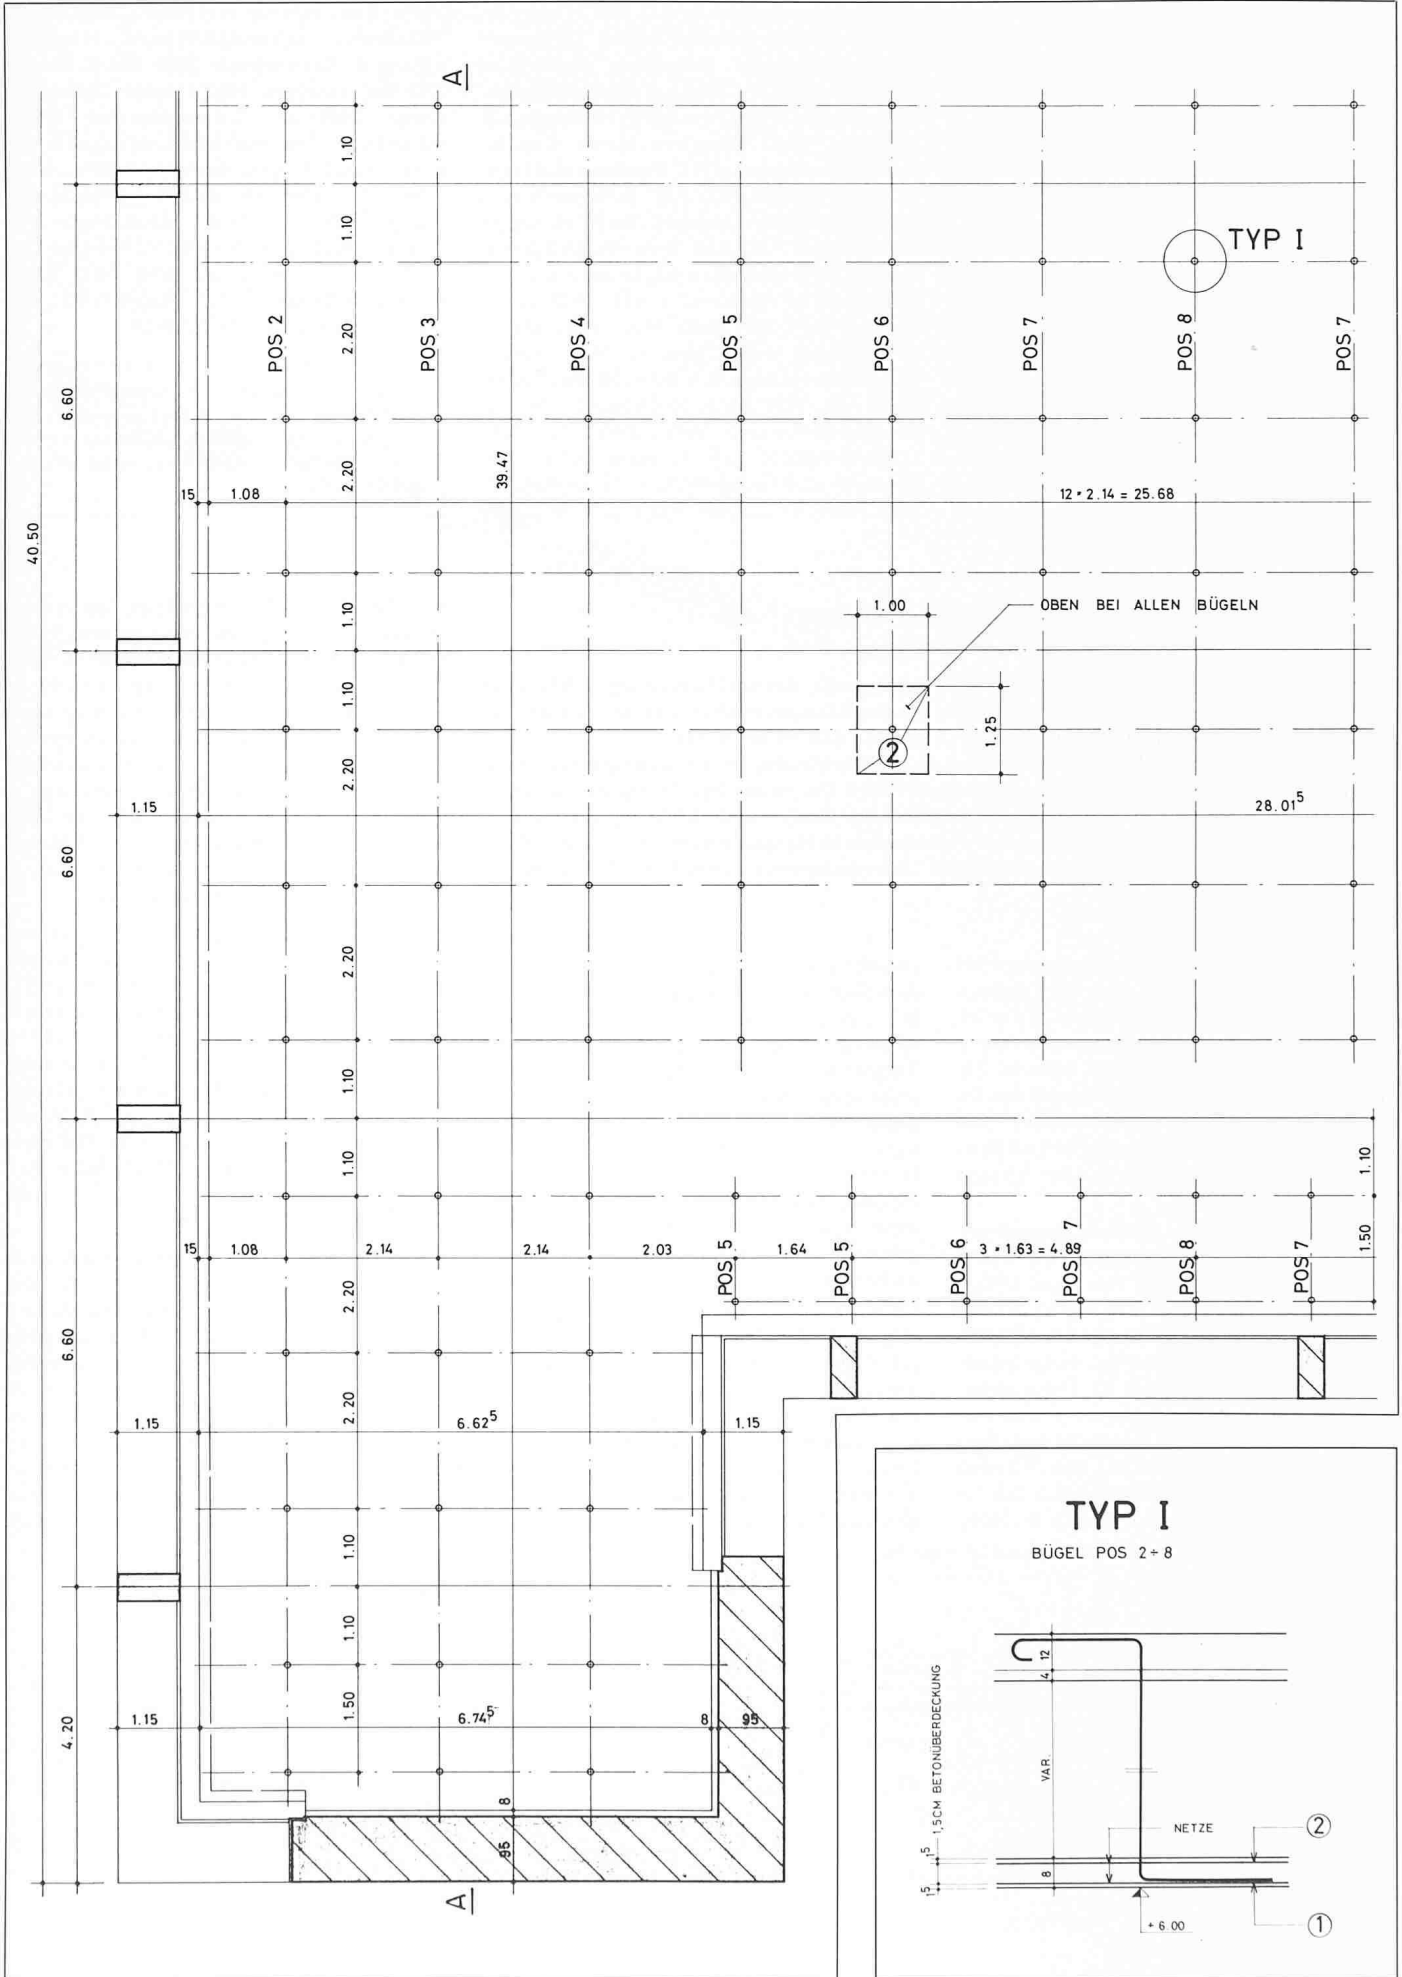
Grundriss der untergehängten Zwischendecke, Ausschnitt
